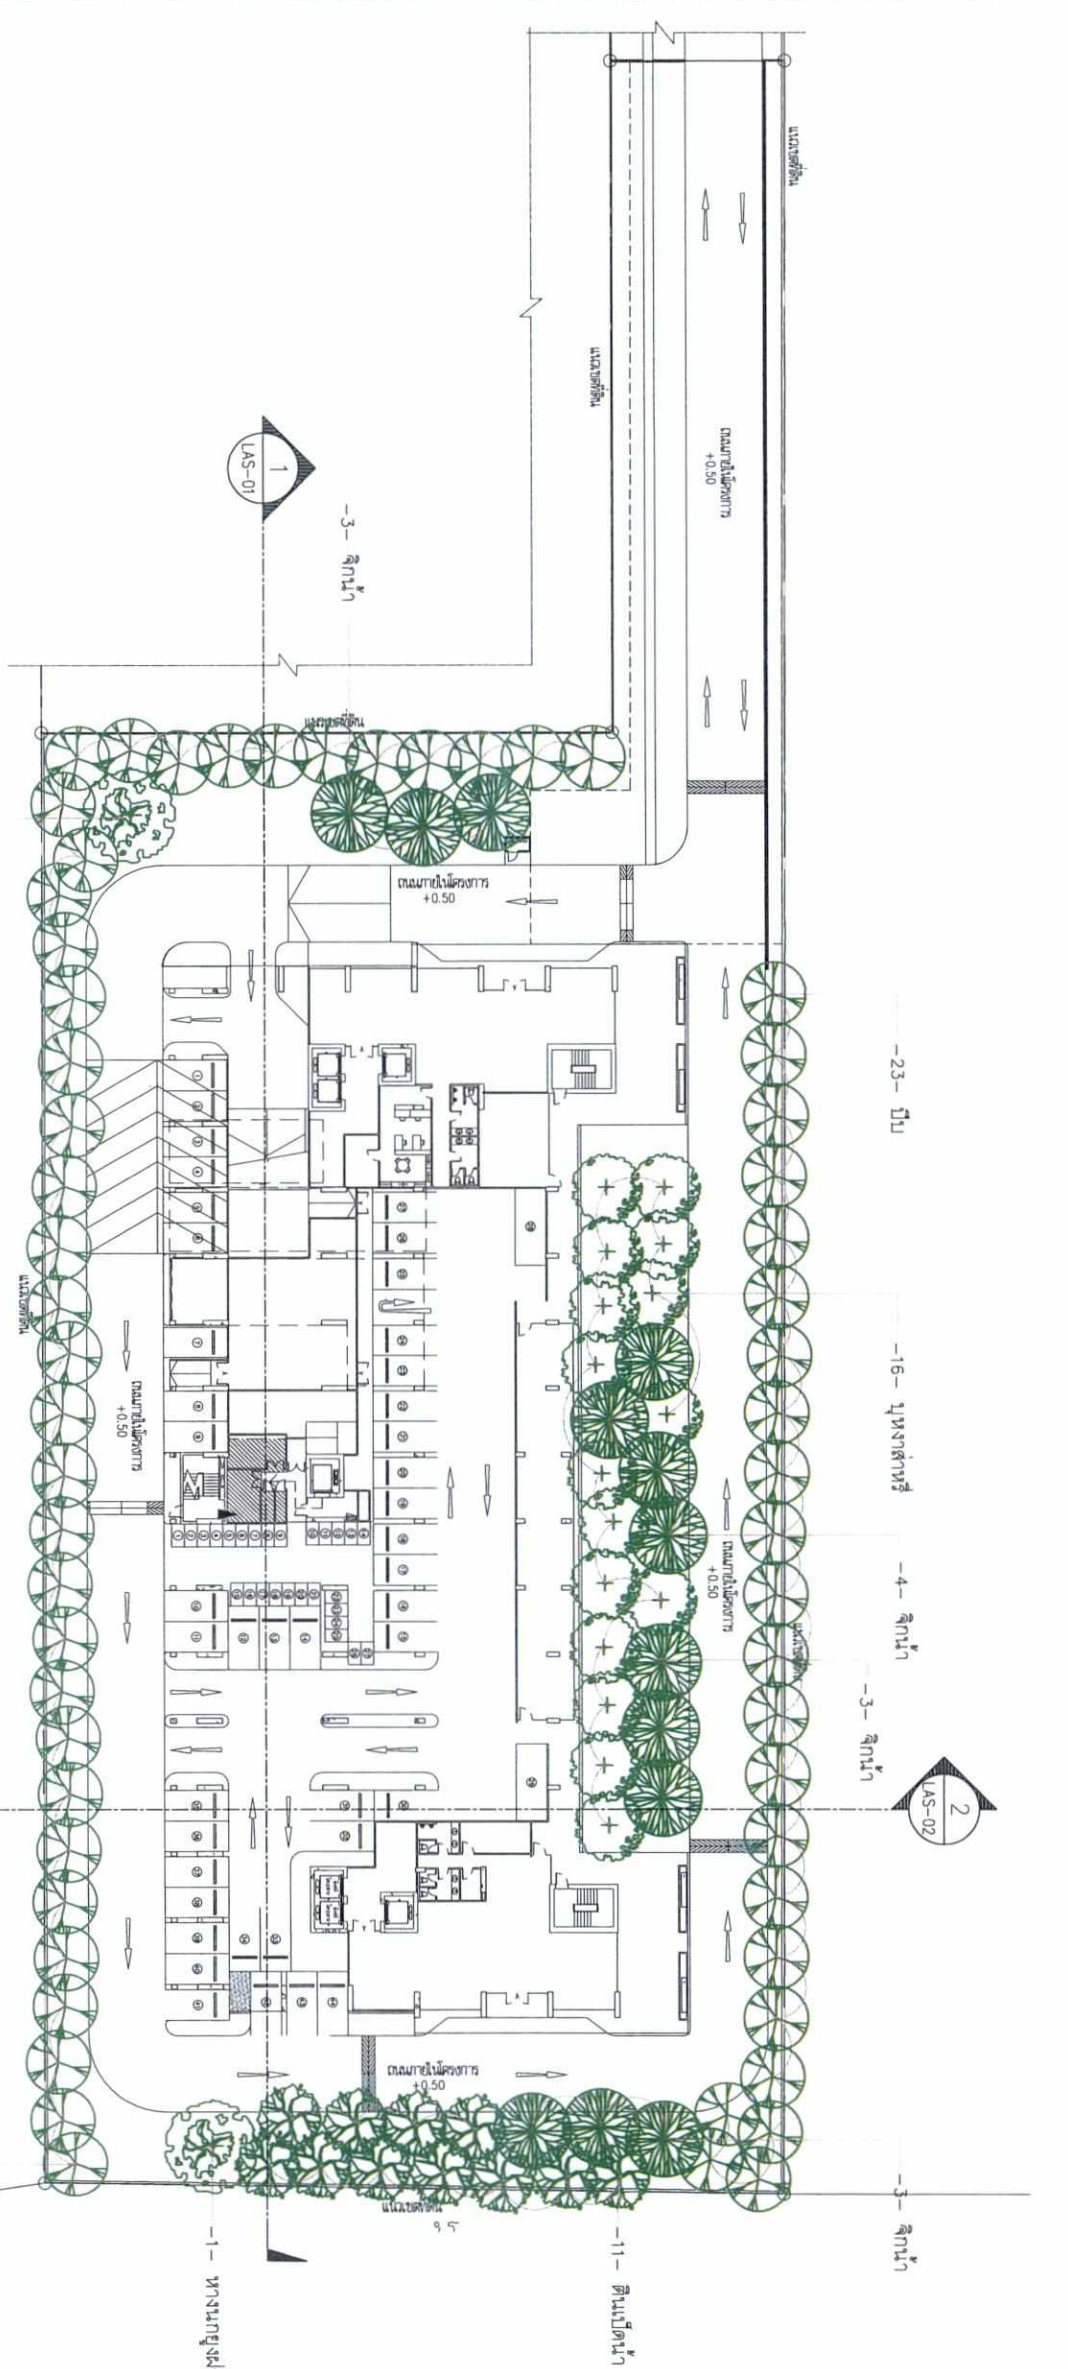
แปลดพื้นที่ใช้สอยสาธารณะชั้นล่างของโครงการ
